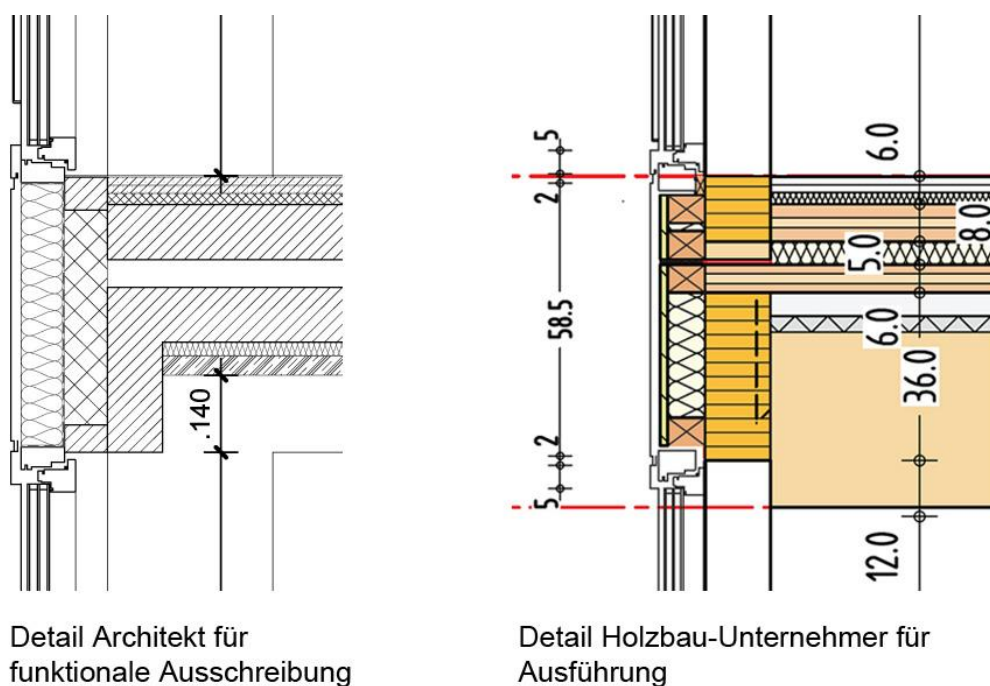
Detailvergleich Leitdetail Architekt – Ausführungsdetail Holzbauunternehmer Bildquelle: Europäische Schule Frankfurt, NKBAK Architekten/Kaufmann Bausysteme
